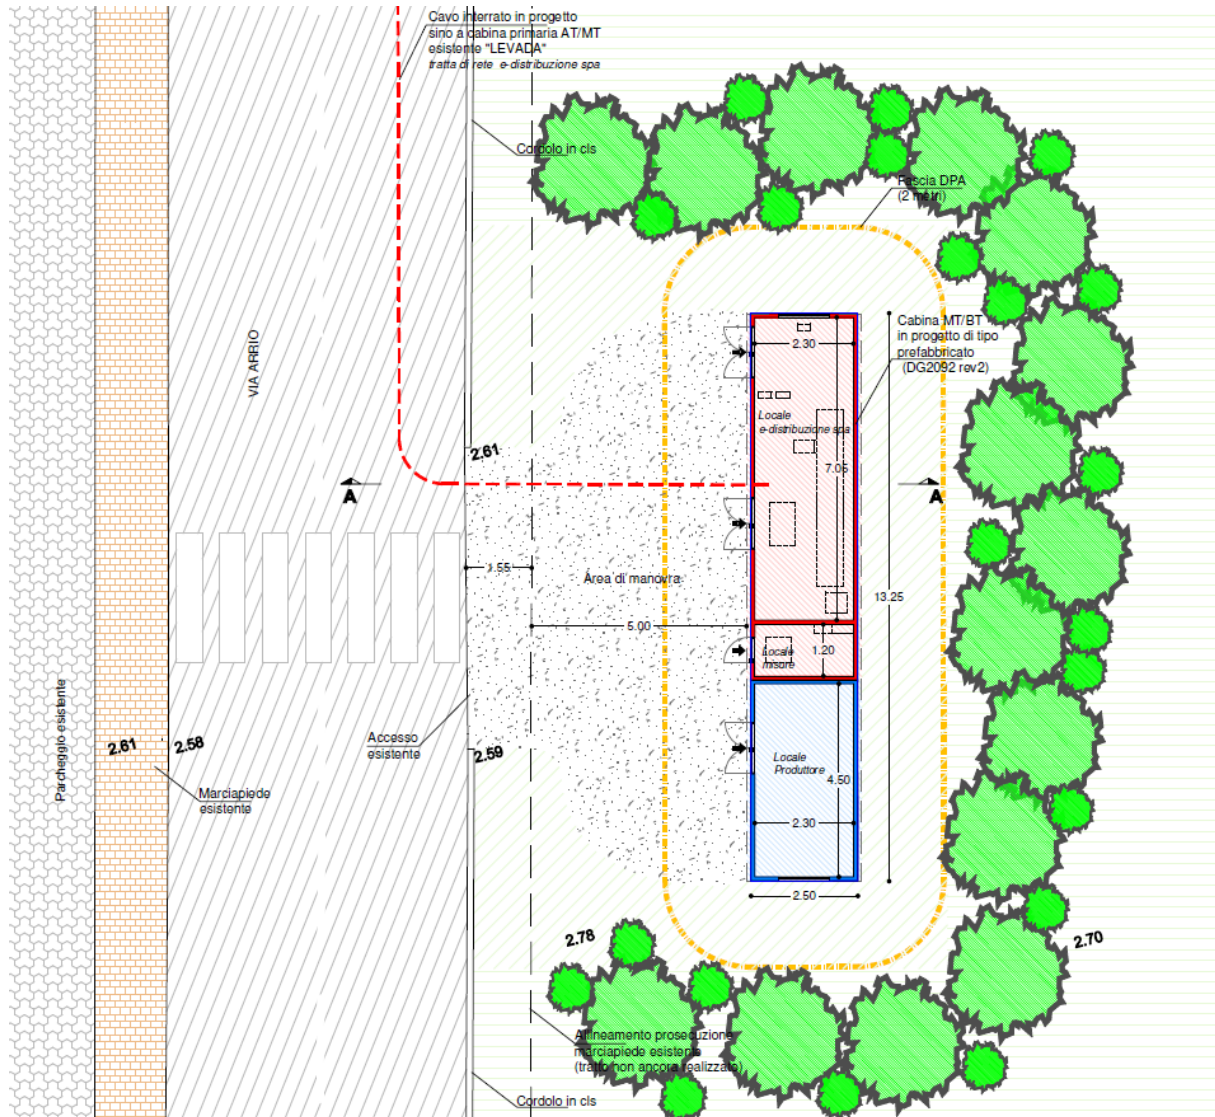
Planimetria di dettaglio dell'area della Cabina di connessione con indicazione della mitigazione visiva
